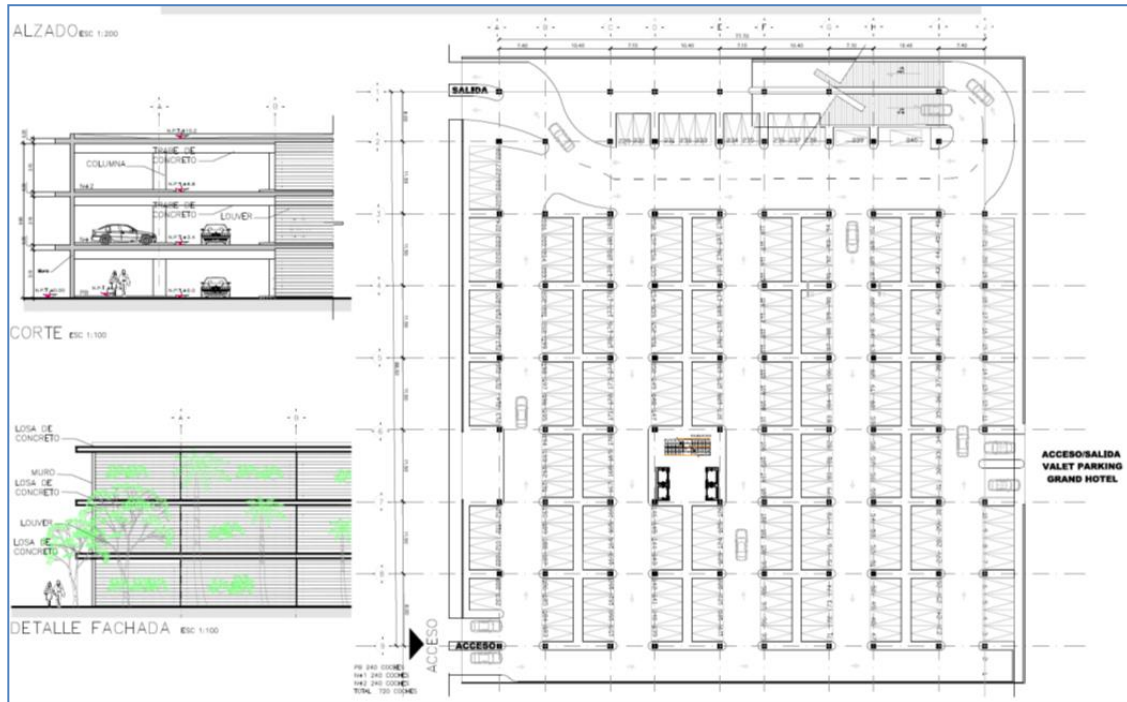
Planta de conjunto, corte y fachada del estacionamiento.
